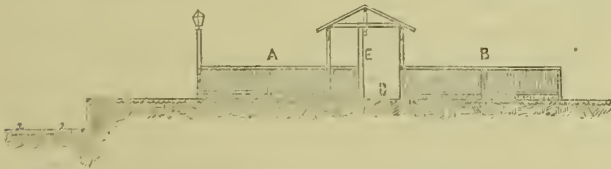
Zählbuchten. Querschnitt (1:250.)
